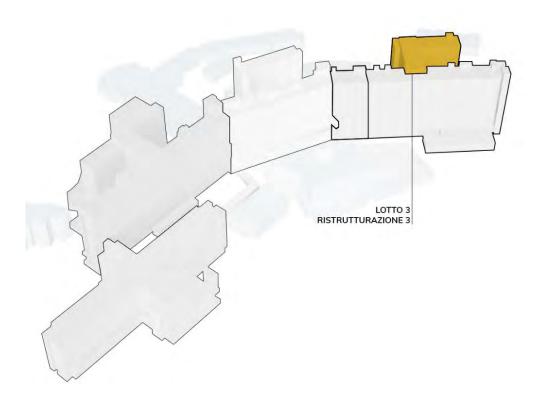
PIANO DEGLI SPOSTAMENTI - LOTTO 3: 3^A RISTRUTTURAZIONE
